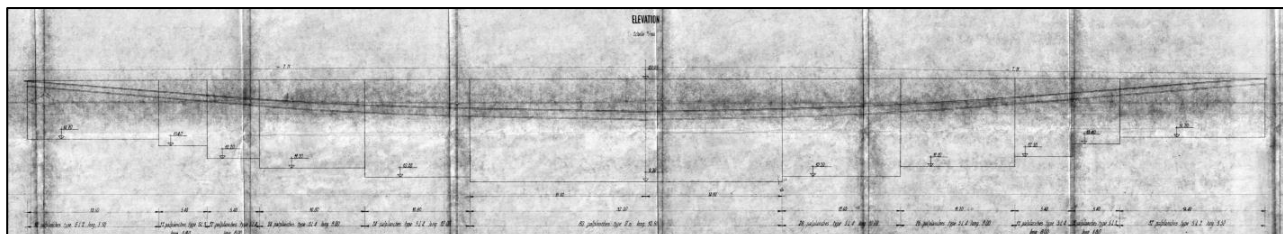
Plan d'élévation des palplanches sous le passage supérieur
